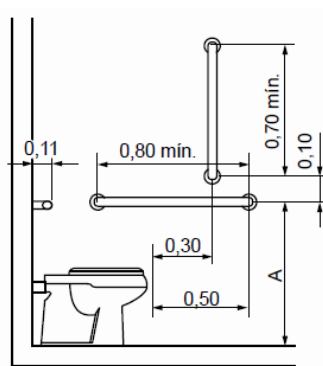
Vista lateral - Instalação de barras horizontais e verticais.
